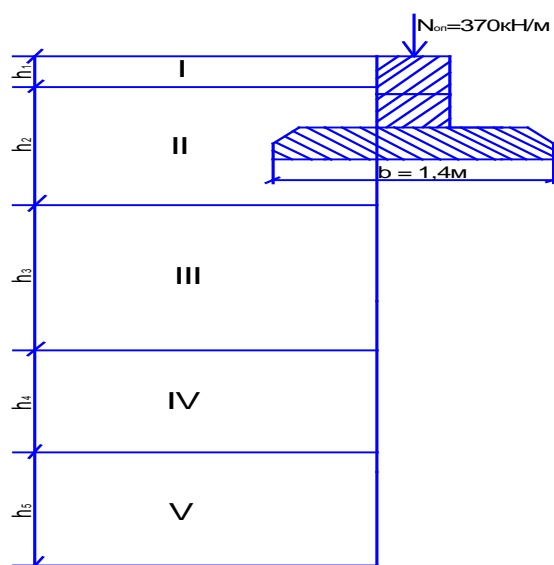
Схема к расчету осадки фундамента методом эквивалентного слоя.
